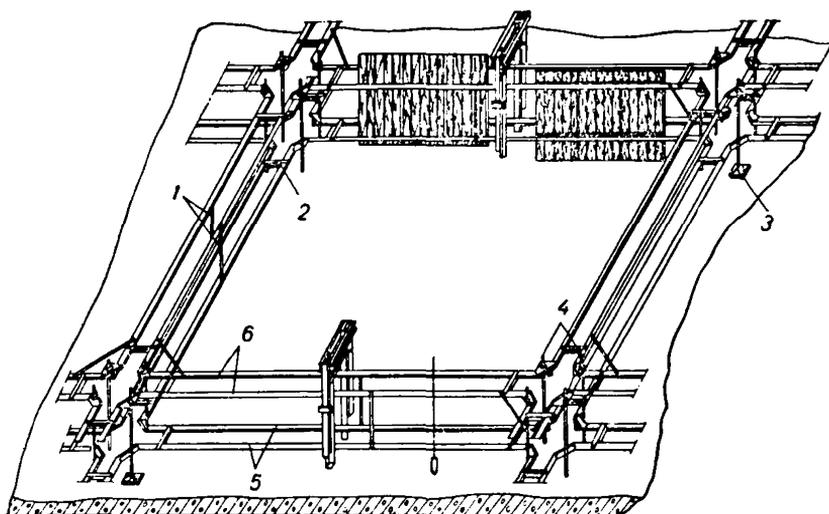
Схема сборки скользящей опалубки на фундаменте:
